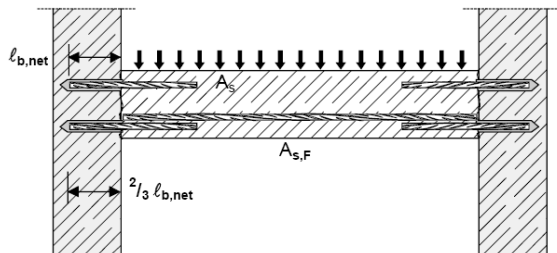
Ancrage direct d'armatures en extrémité de dalles ou poutres, simplement appuyées.
